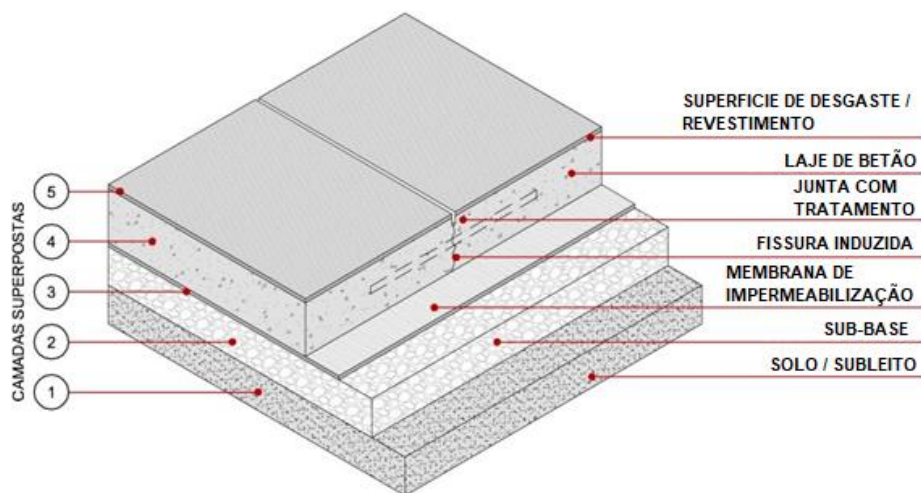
Sistema construtivo de um pavimento industrial [adaptado de Cristelli (2010)]
